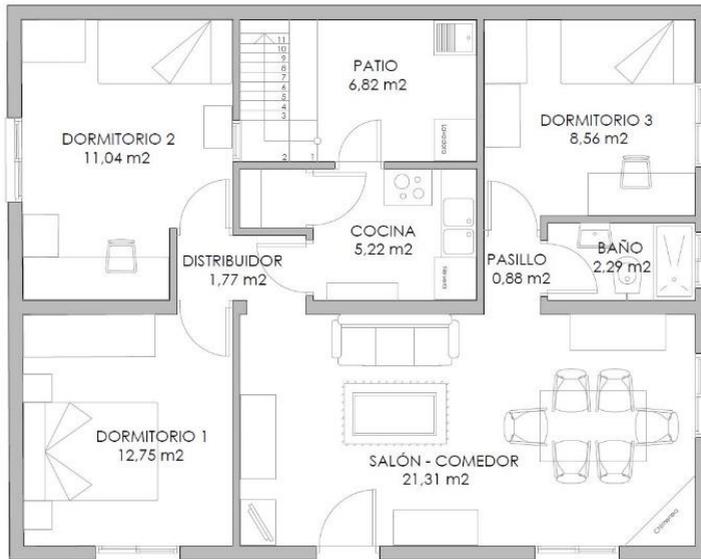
Planta distribución estado actual. 2022. Fuente Propia
